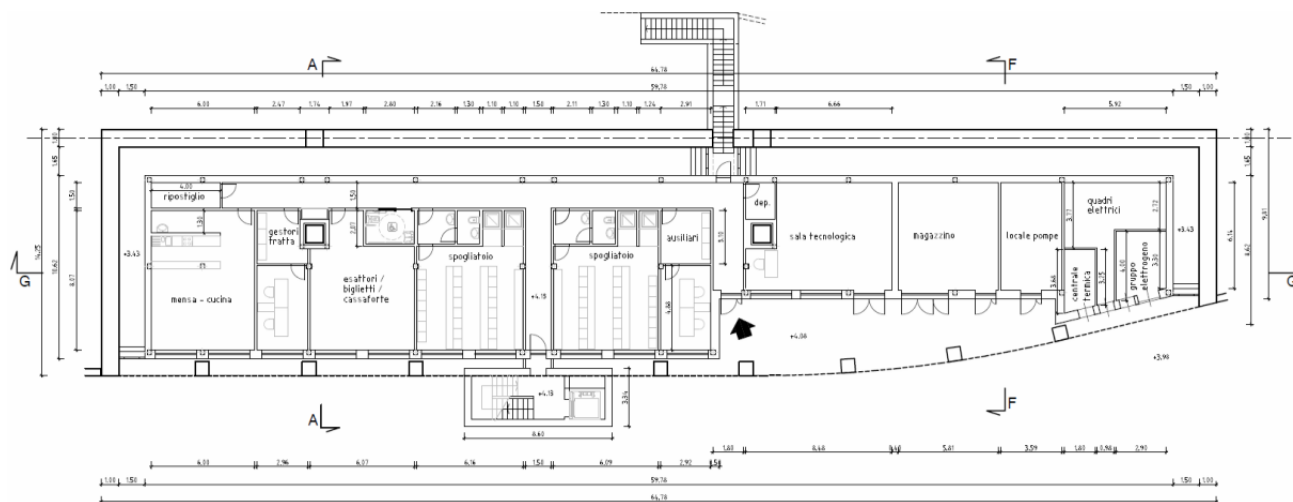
Pianta del nuovo fabbricato di stazione seminterrato (tratta dalla tavola I.00.05.0.0).
